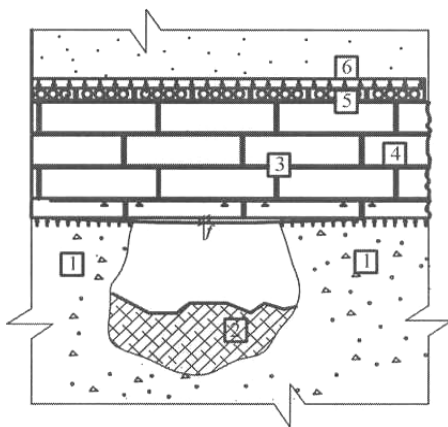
Схема сборного ленточного армированного фундамента над карстовым провалом:
